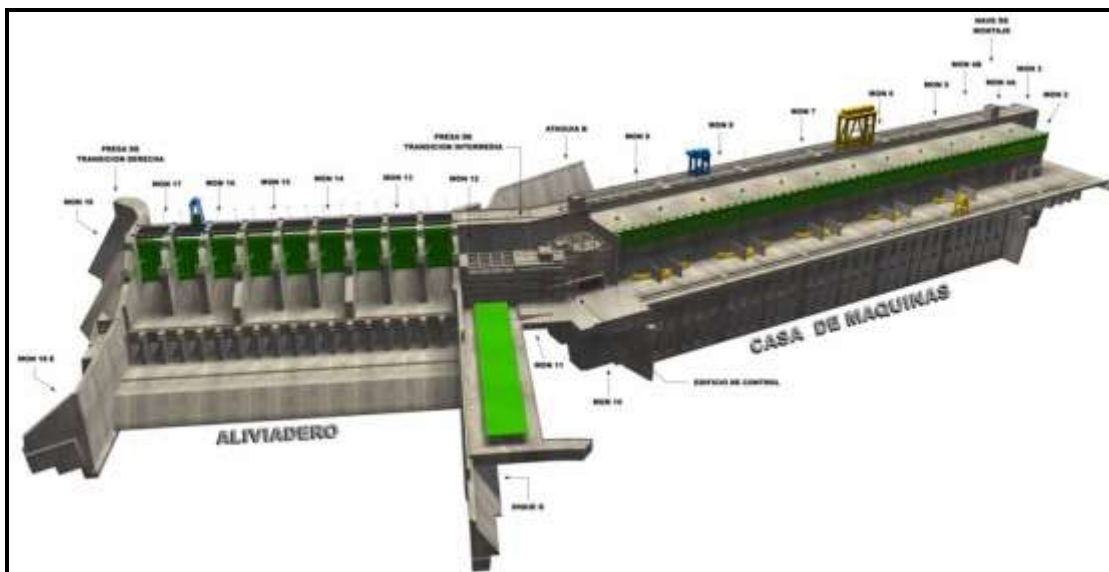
Vista General de Obras en Concreto del Proyecto Tocomá.
